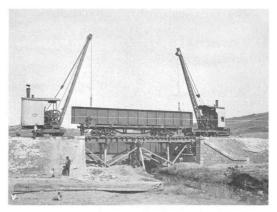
Incidente en la construcción del puente sobre el río Nela al fallar la pila provisional central del vano más cercano al estribo con la caída de un vagón del tren de trabajo y la locomotora en posición inestable
